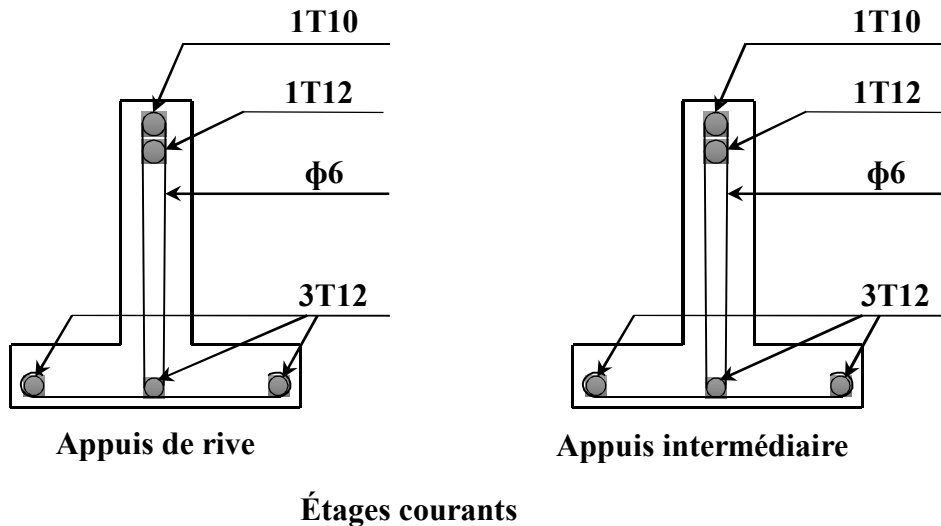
Dessin de ferrailage des poutrelles des étages courants.
